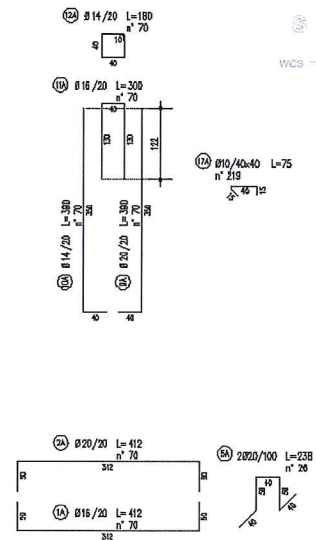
Schema armatura – Muro tipo 3 –Concio 16 e da 18-23
